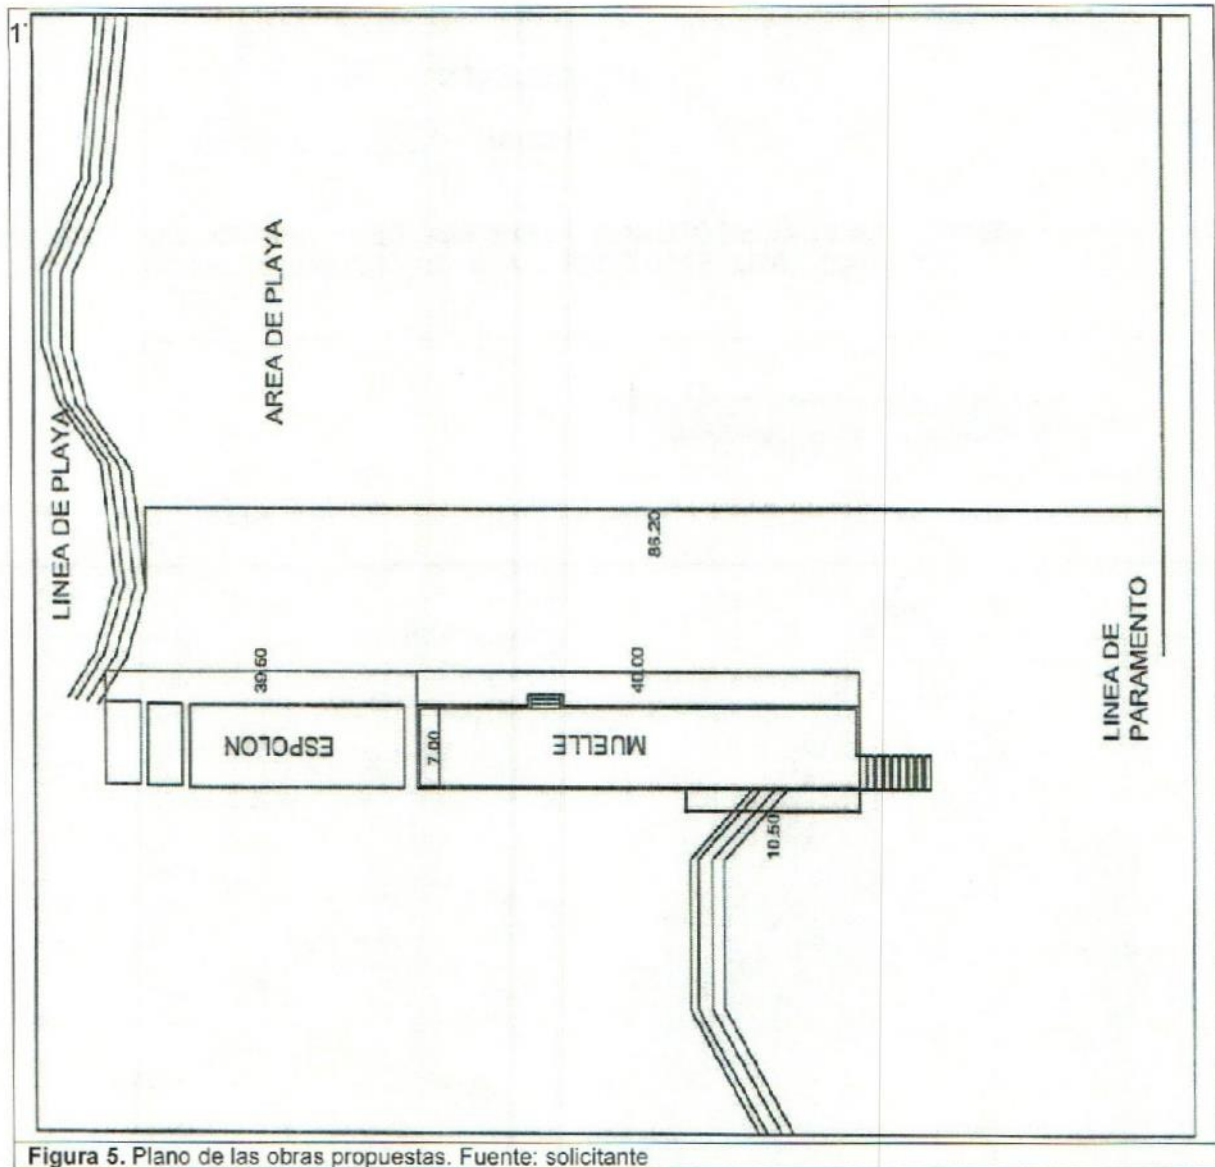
Plano de las obras propuestas. Fuente: solicitante
